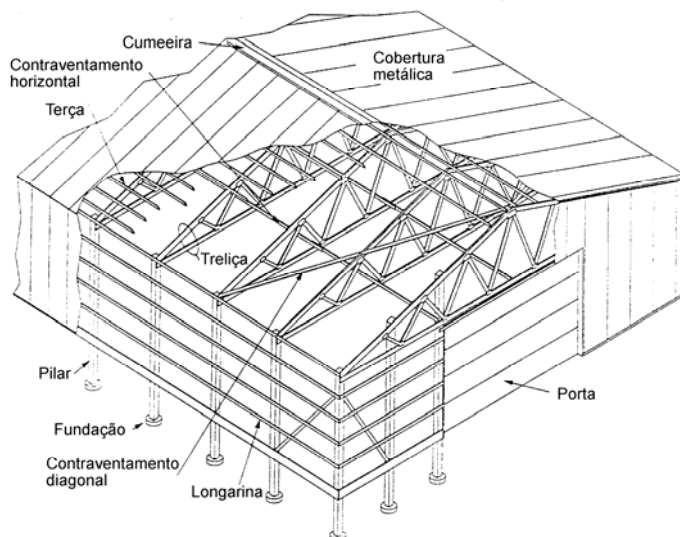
Pórtico treliçado (Fonte: Gebremedhin, 1992)
